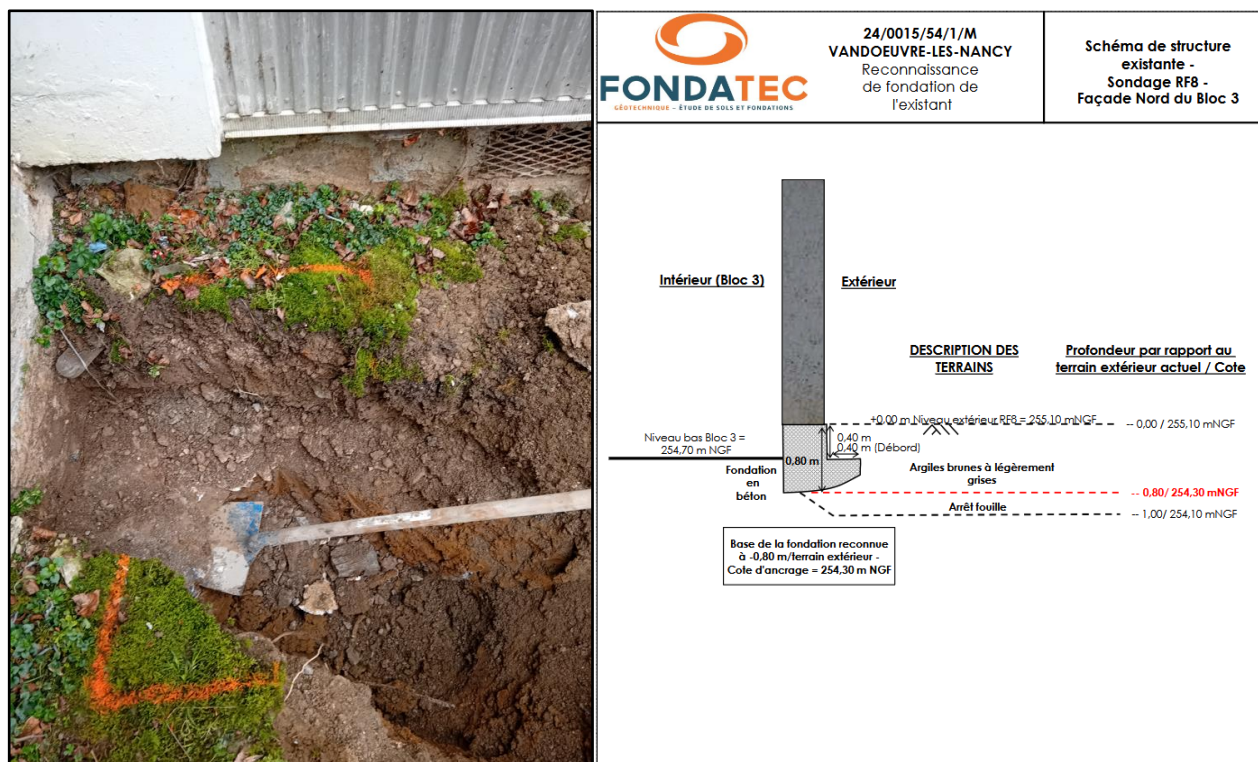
Photographie et coupe de la reconnaissance de fondation RF8 du bloc 3
